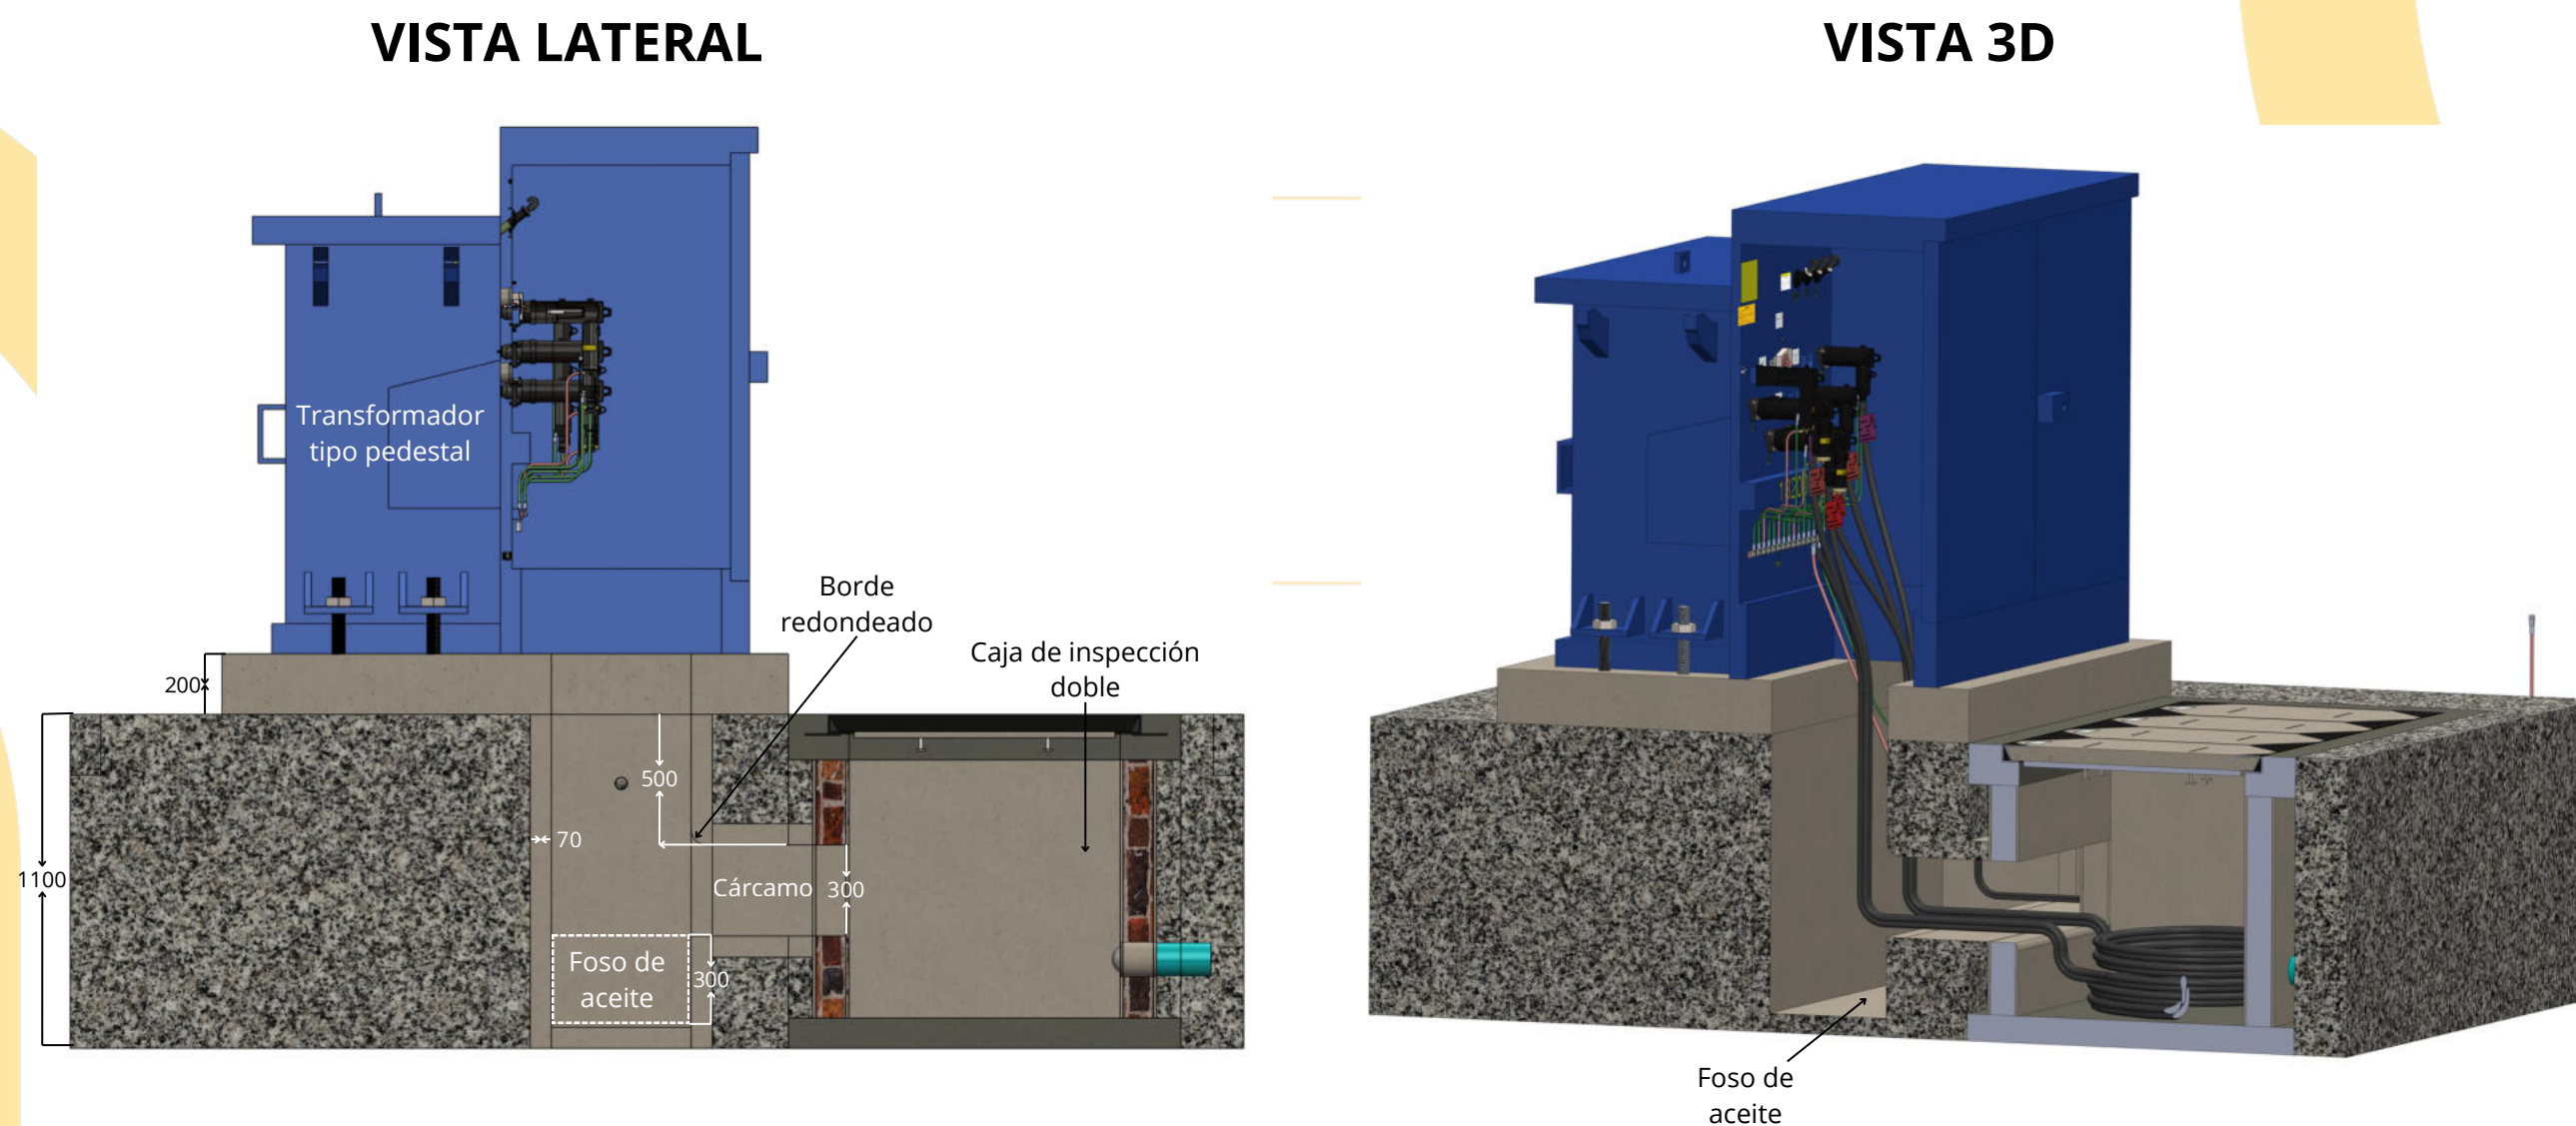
Detalle constructivo de obra civil para cárcamo y fosa de retención de aceite en transformador tipo pedestal
